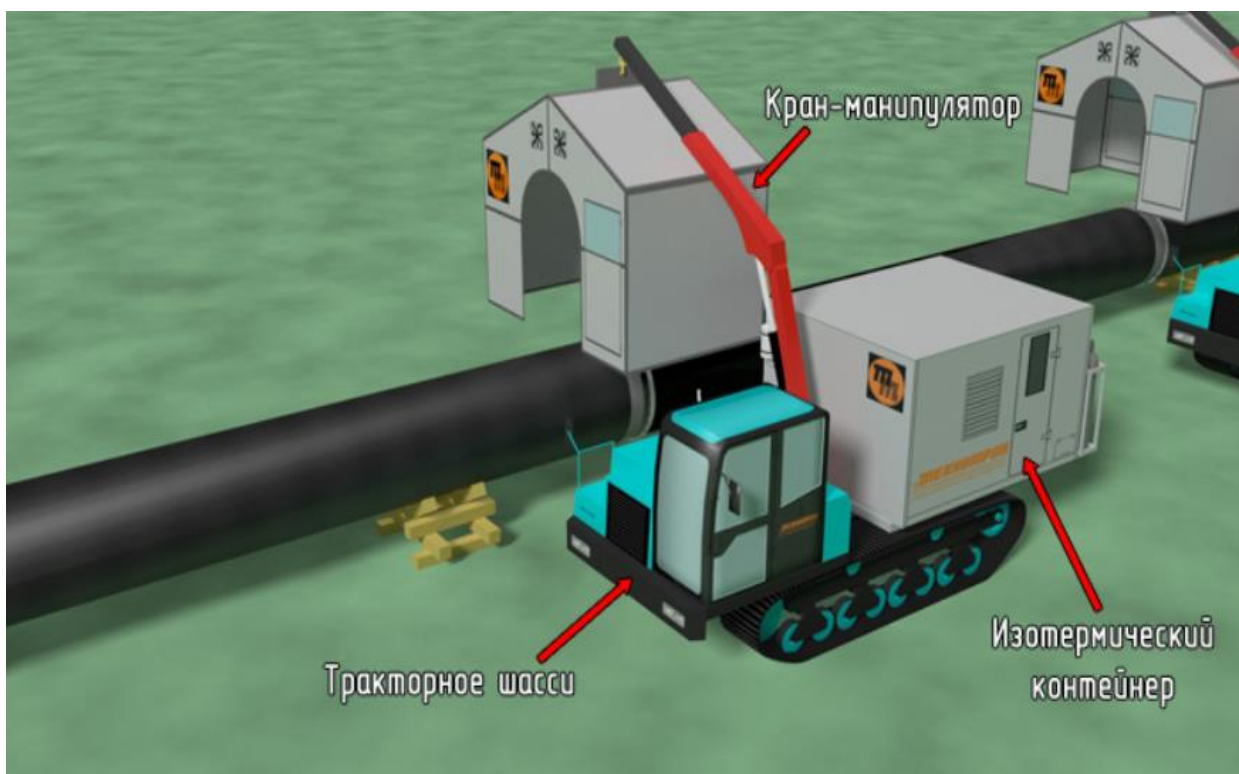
Агрегат самоходный сварочный МКСТ-34 с защитной палаткой
